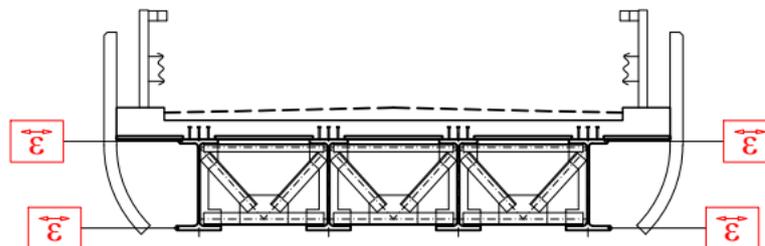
Ubicazione sensori su impalcato sezione a 4 travi (sezione trasversale viadotto Rampa Cappio Ovest)
